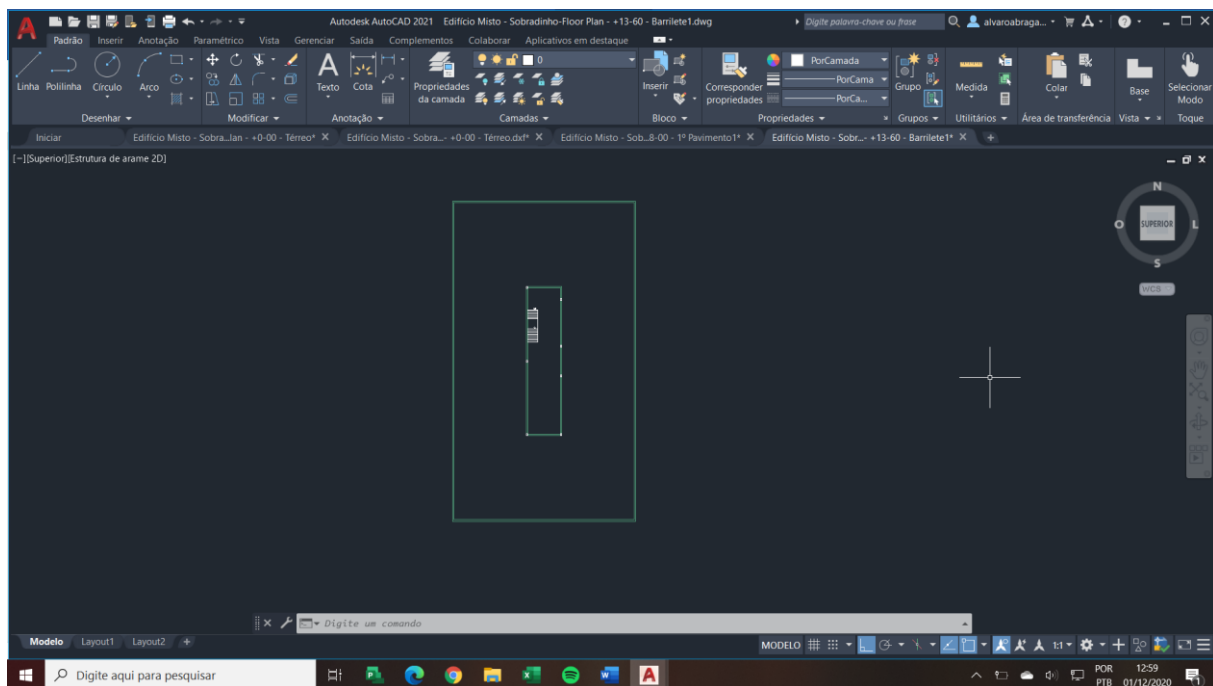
Planta baixa do barrilete, em DWG. Realizado pelo autor.
